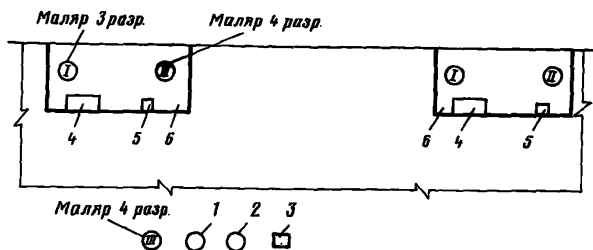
Схема организации рабочего места при покраске фасада вручную с помощью валика
